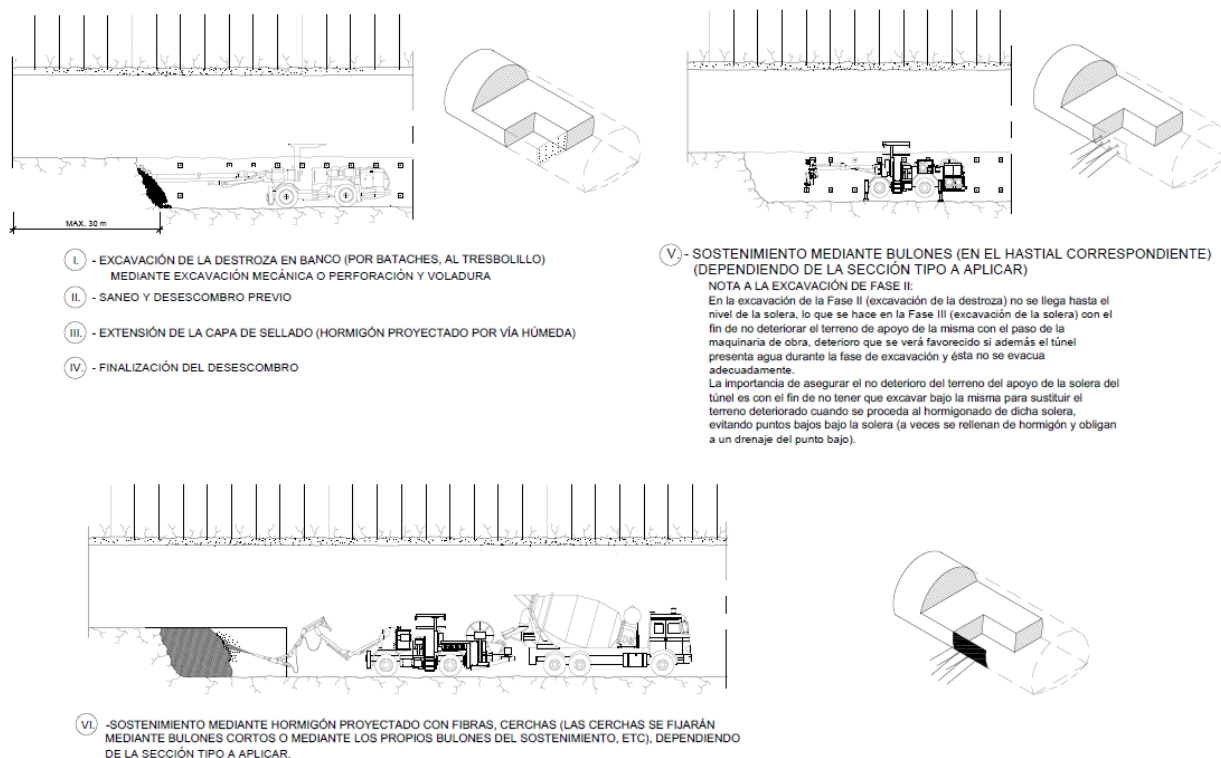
Fase de excavación en la sección de Destroza, primer hastial
